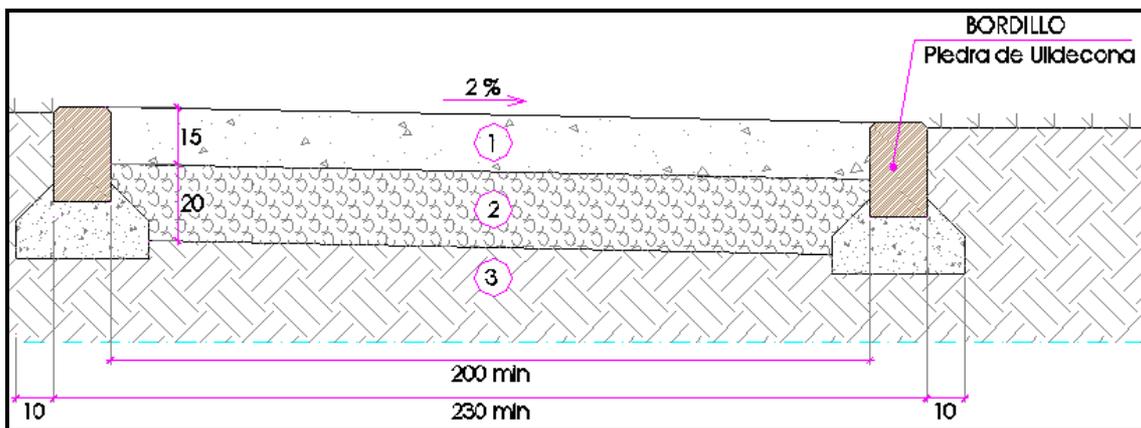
Detalle del sendero de hormigón peinado, donde 1= Hormigón peinado (con mallazo 0.6x0.15x0.15) juntas con corte radial 2= Zohorra artificial y 3= Pedraplen o terreno natural tratado y compactado.
